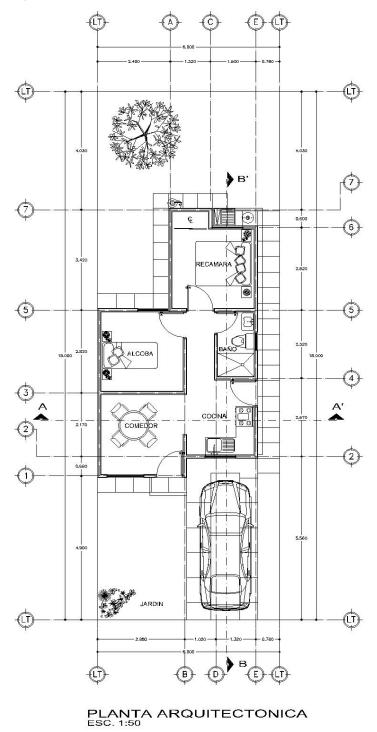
Imagen de la planta arquitectónica de la vivienda.
